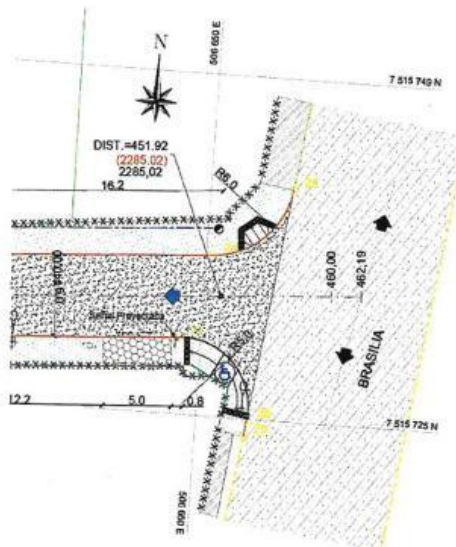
Intersección de calle General Salvo con calle Uruguay proyectada, donde se mantienen aceras de hormigón y soleras tipo A existentes.
